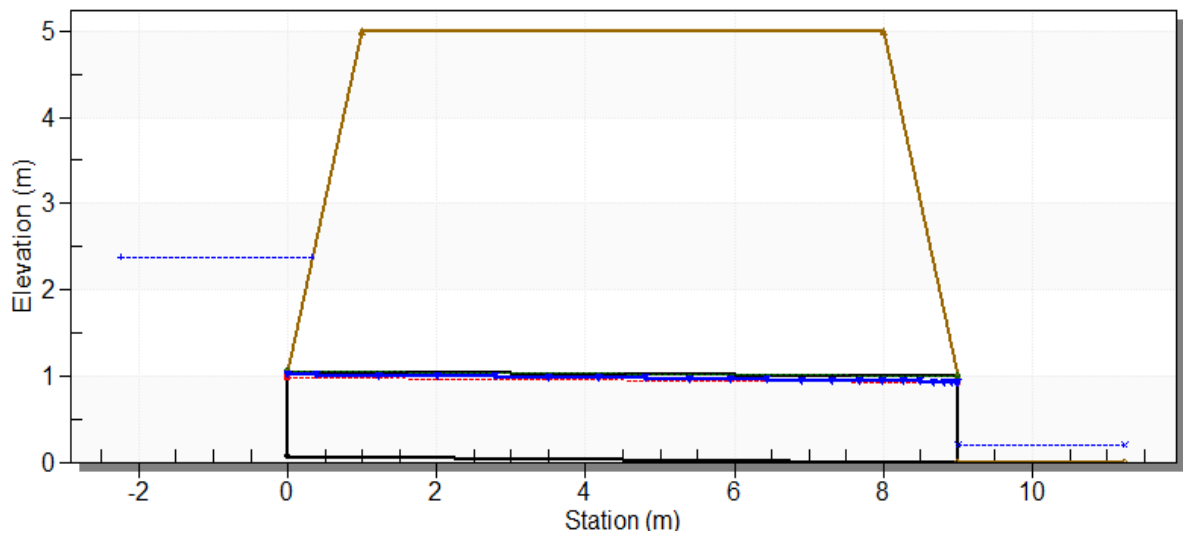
Desing Culvert. Concreto Reforzado 1000 mm
